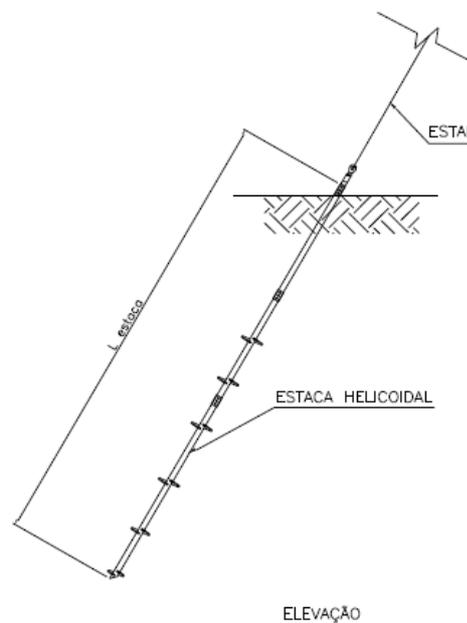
Layout* da fundação tipo estacas helicoidal.
